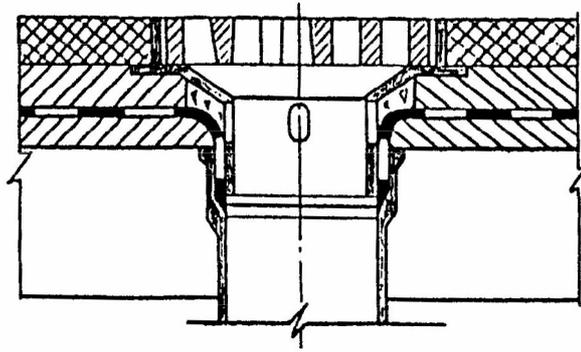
Сопряжение гидроизоляции с водоотводной трубкой
